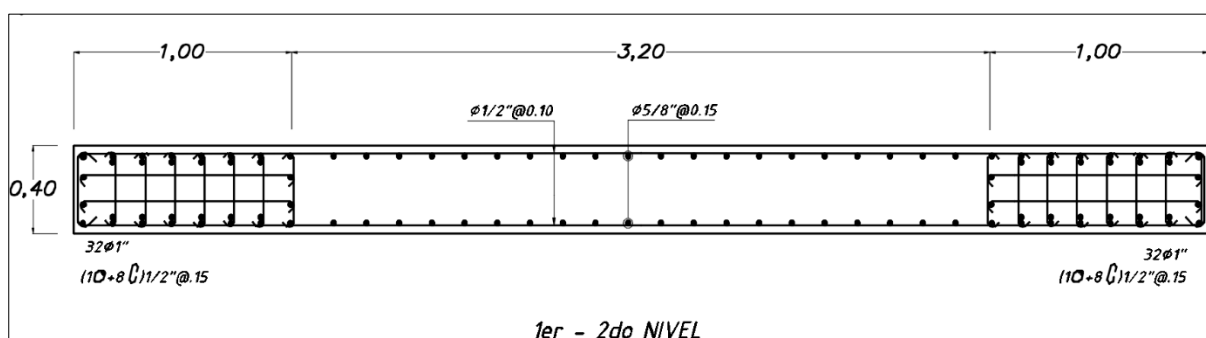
Detalle de refuerzo de "Muro 4", Elaboración propia
